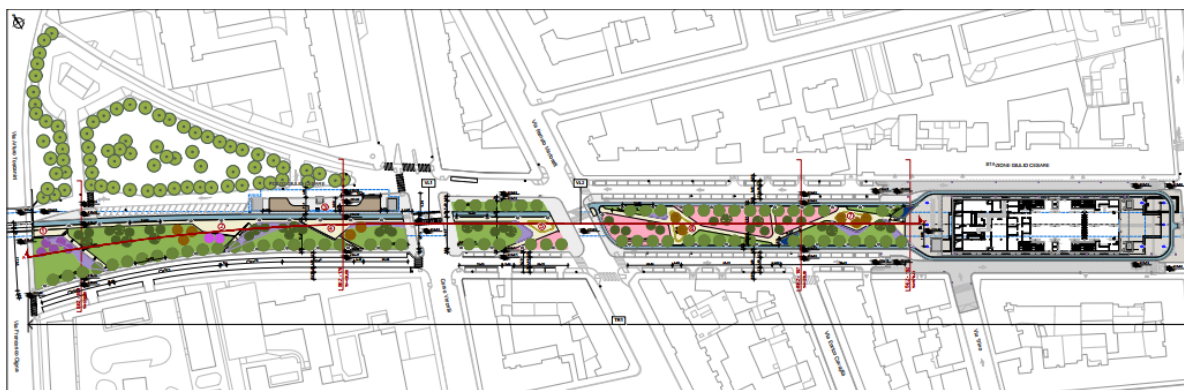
Planimetria TR1 tra Via Cigna e Stazione Giulio Cesare
